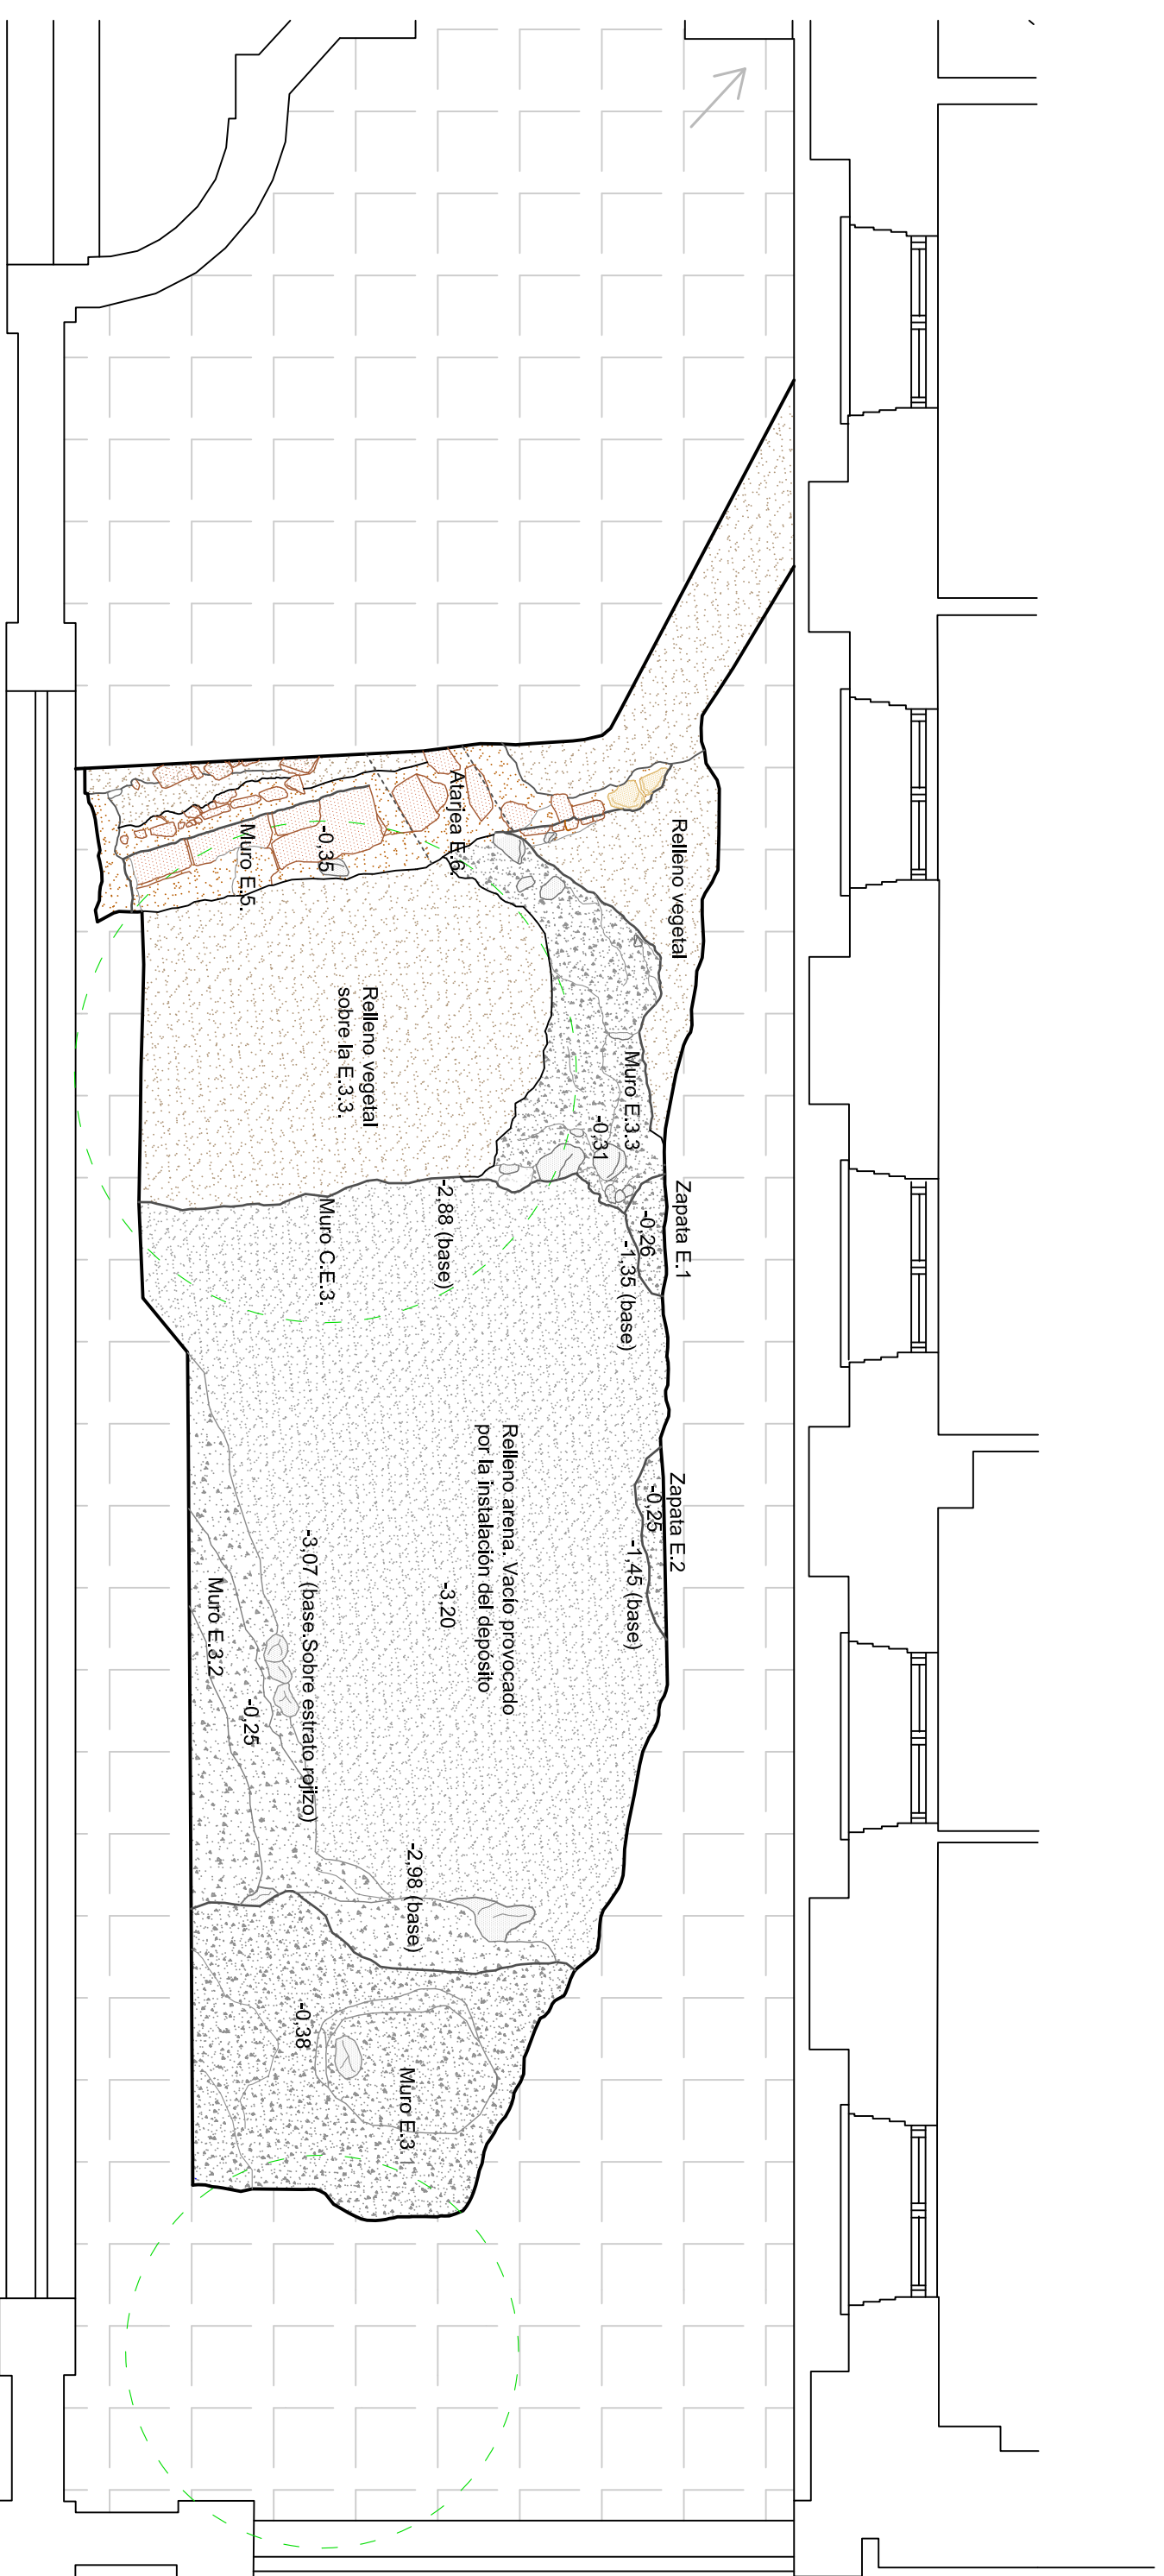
Superposición de la planta general de la excavación sobre la planta de la fachada del convento. Año 1908.
